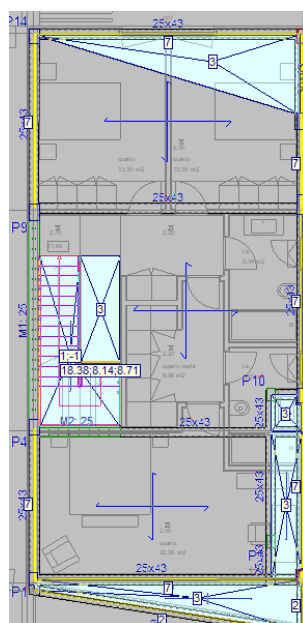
Lajes Maciças do Piso 1 (Fonte: CYPE)
